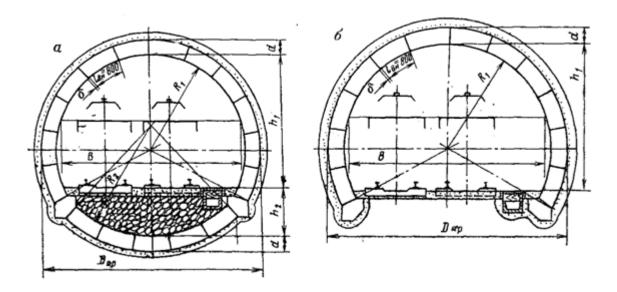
Сплошные блочные бетонные крепи конструкции Донгипрошахта: а – БКЗ; б - БКА
